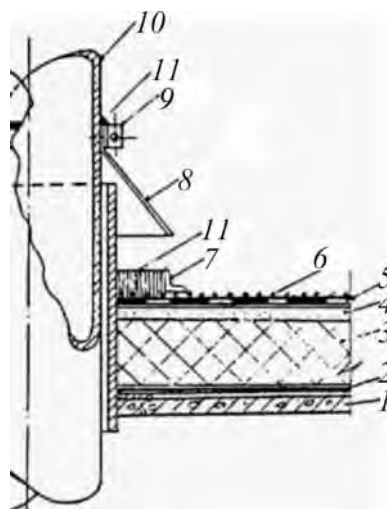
Примыкание кровли к трубе: *1* — железобетонная плита покрытия; *2* — пароизоляция; *3* — теплоизоляция; *4* — выравнивающая стяжка; *5* — основной кровельный ковер; *6* — крупнозернистая подсыпка верхнего слоя кровельного ковра; *7* — рамка из уголка; *8* — зонт; *9* — хомут; *10* — труба; *11* — патрубок с фланцем
